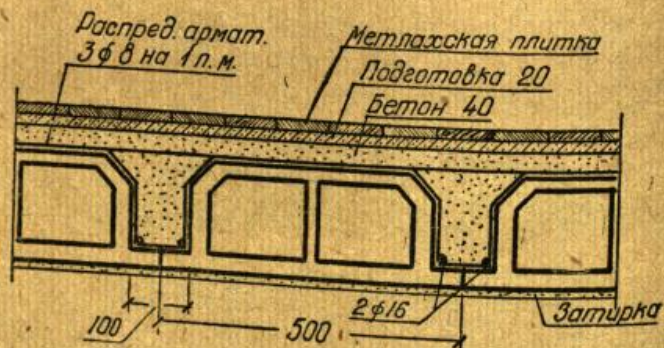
Сборное железобетонное перекрытие с ксилоцементными пустотелыми камнями.
